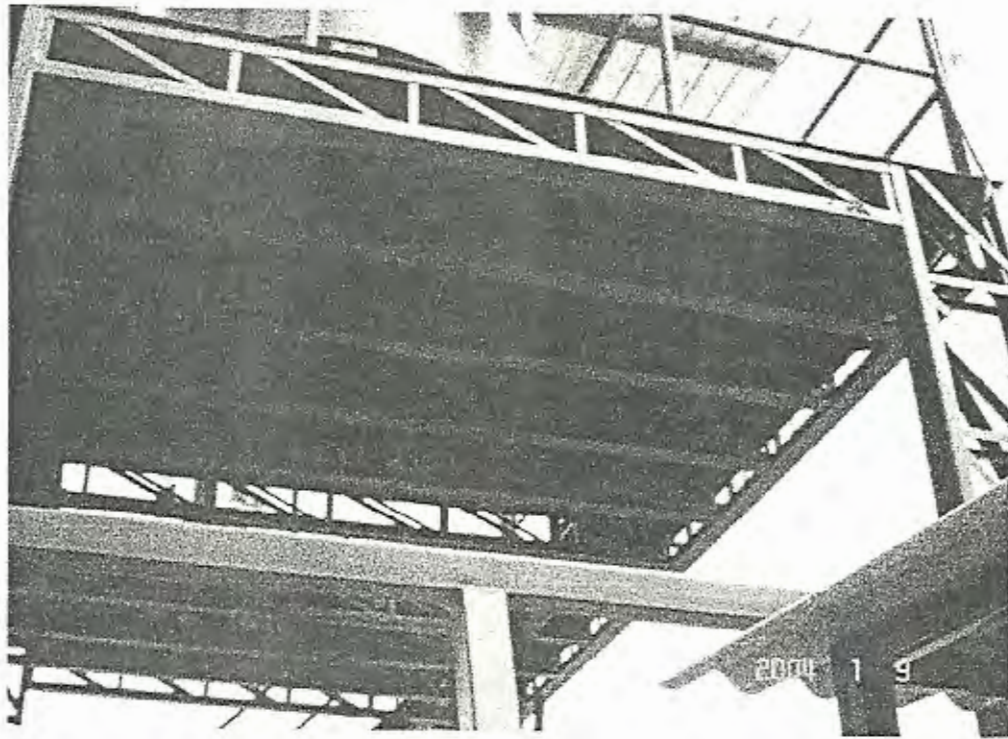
VIGAS SOPORTES DE TORRE DE CALIBRACIÓN.
